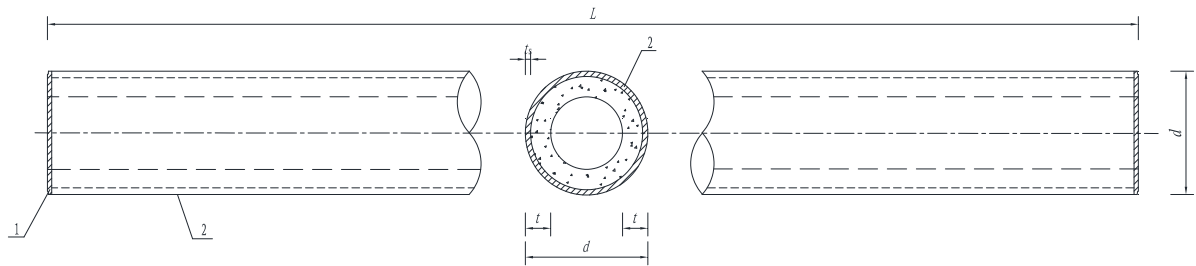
管桩（高强钢管混凝土管桩）结构形式示意图
